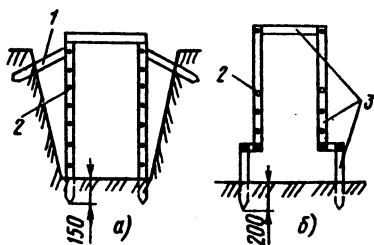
Шаблоны для кладки бутовых ленточных фундаментов: а — без уступов, б — с уступами; 1 — подкос; 2 — отверстия для шнура-причалки, 3 — деревянные бруски
